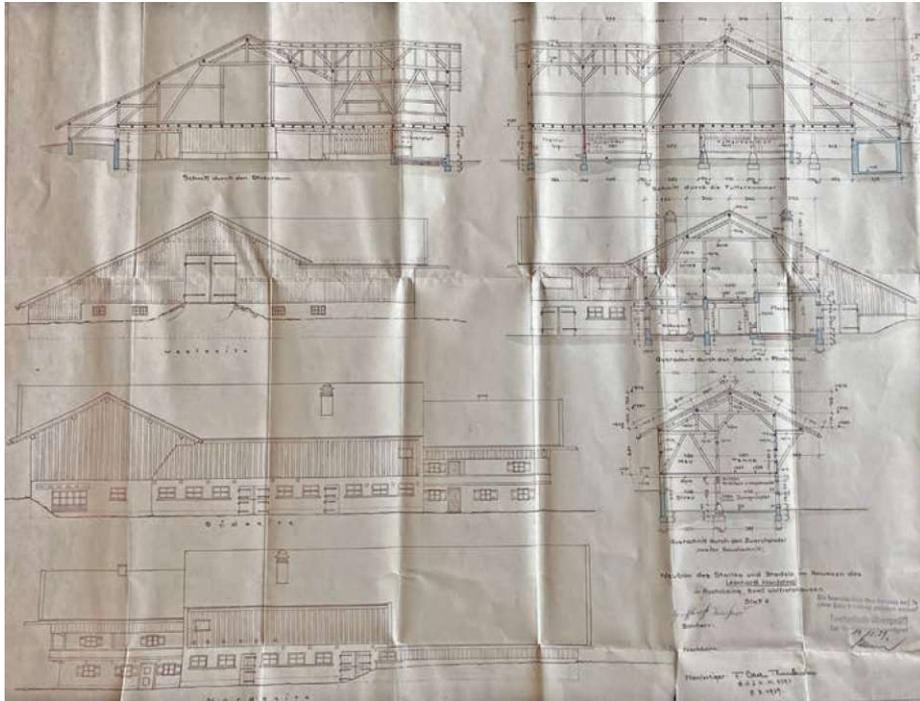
Genehmigungplan Umbau Stallungen, 1939
